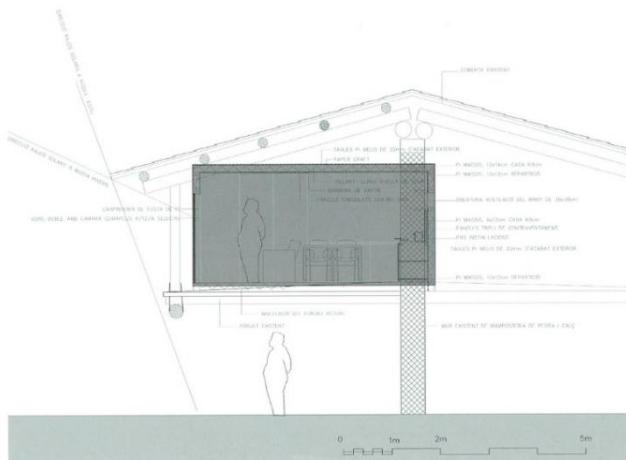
Sección constructiva [Revista DAU nº 30-31]
